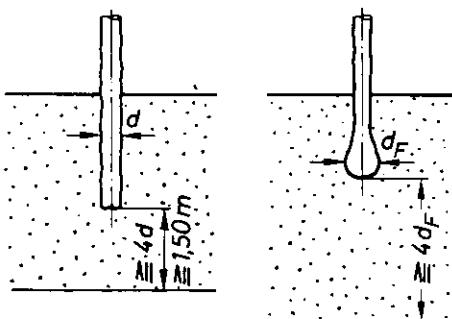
Erforderliche Tiefe des tragfähigen Baugrunds
